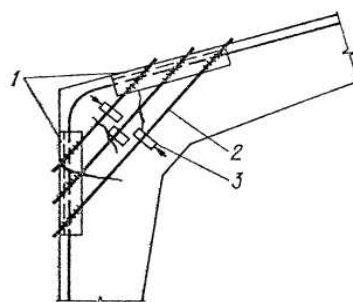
Усиление карнизного узла Г-образной рамы: 1 – колодки из уголков, 2 – дополнительная арматура, 3 – плоские клинья для напряжения
